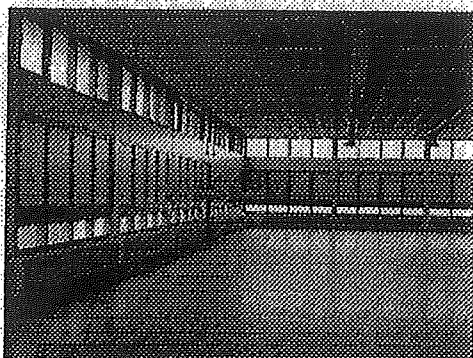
brontype 03, Cementgebonden sandwichpaneel
